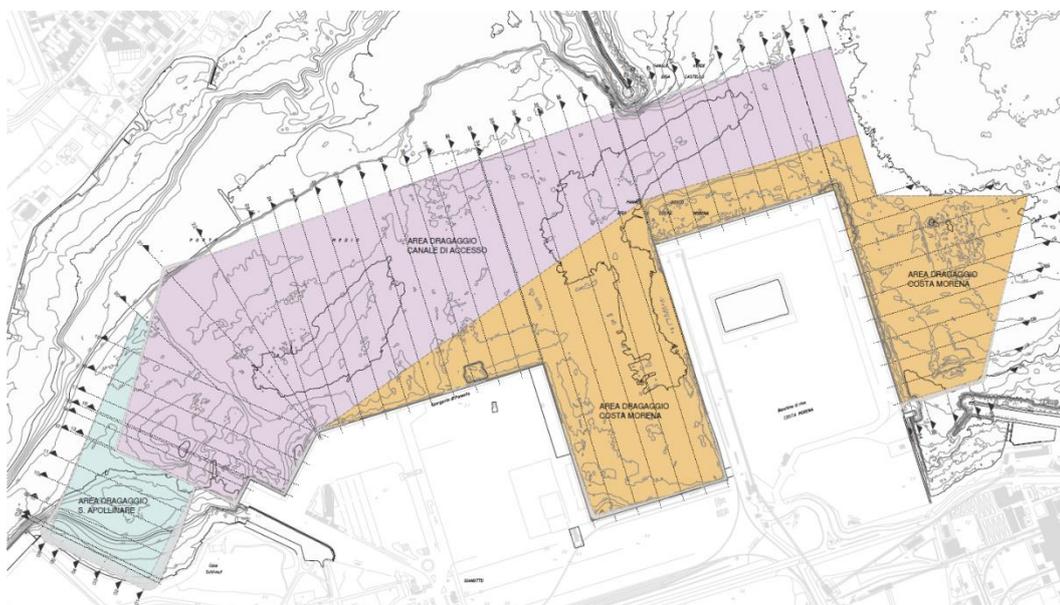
Stralcio della planimetria generale di dragaggio (Cfr. 09-017-DT-202-1-PLA)
